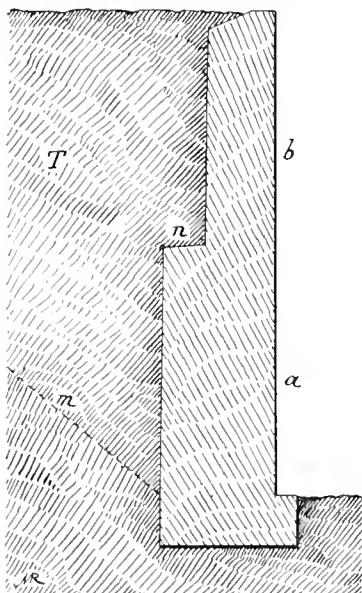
Coupe verticale d'un mur de soutènement à redan.
